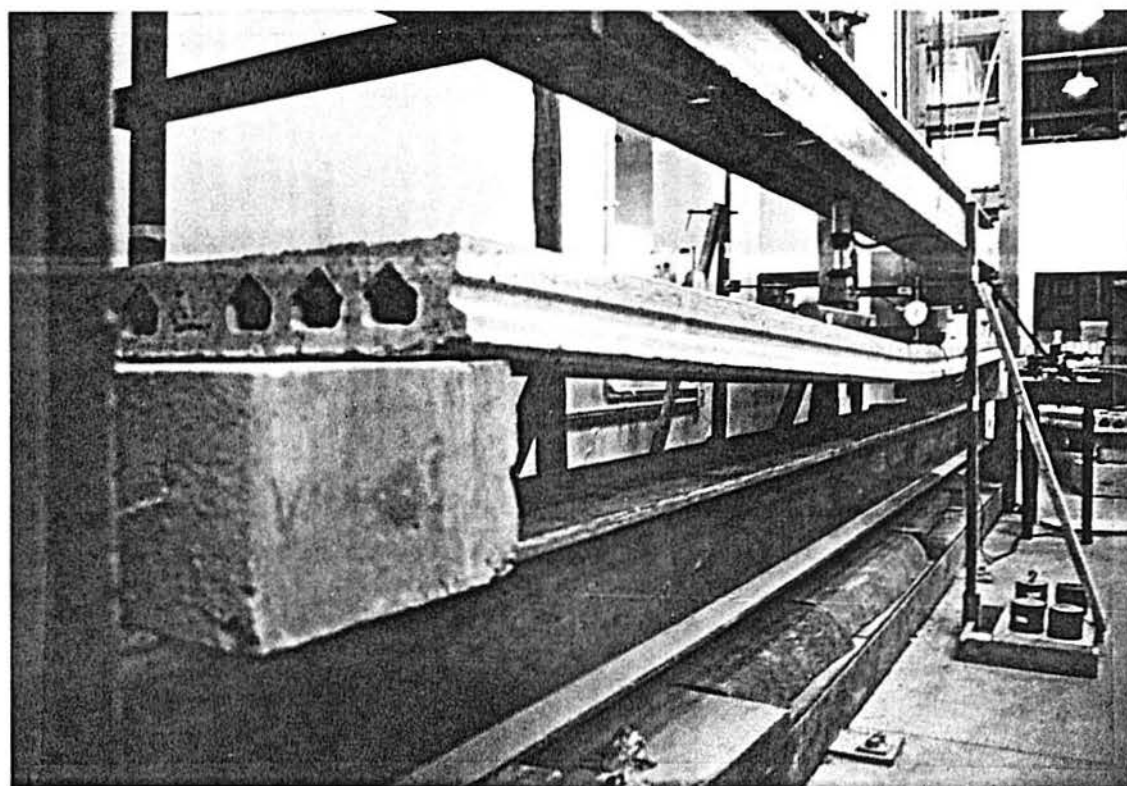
Vista do protótipo B1, durante o ensaio de carregamento até a ruptura
